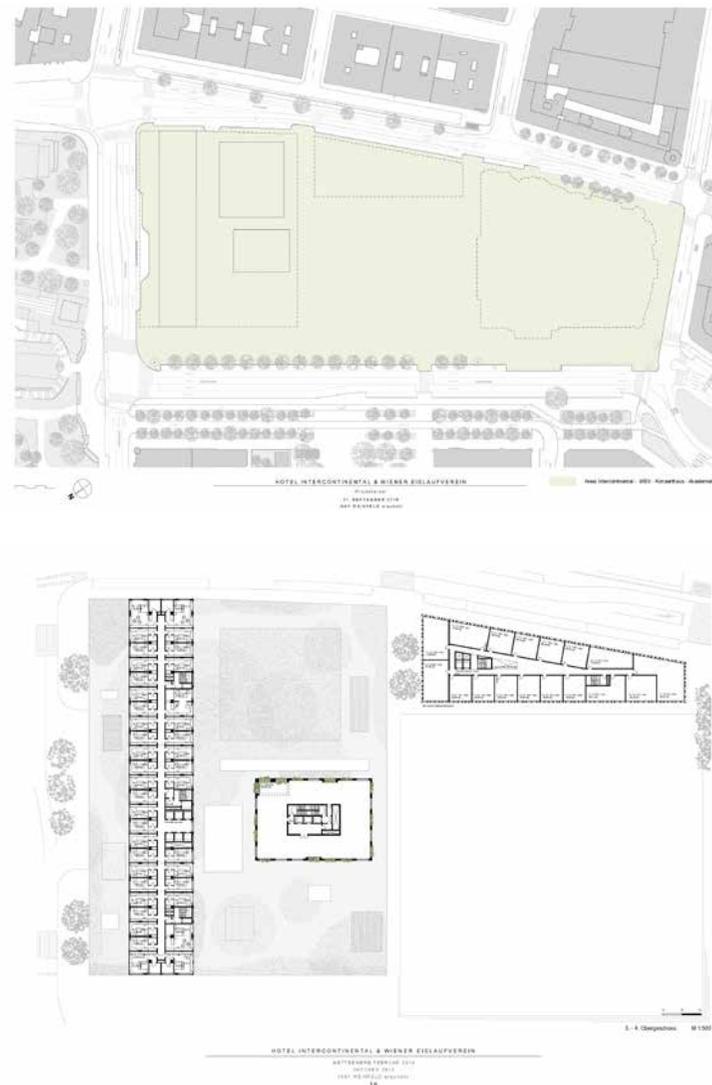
,b: Positionierung der Volumenkörper des aktuellen Entwurfs, Stand 09/2018 (oben), Grundriss des Wettbewerbentwurfs 2014/15 (unten) © WertInvest / Isay Weinfeld & Sebastian Murr
